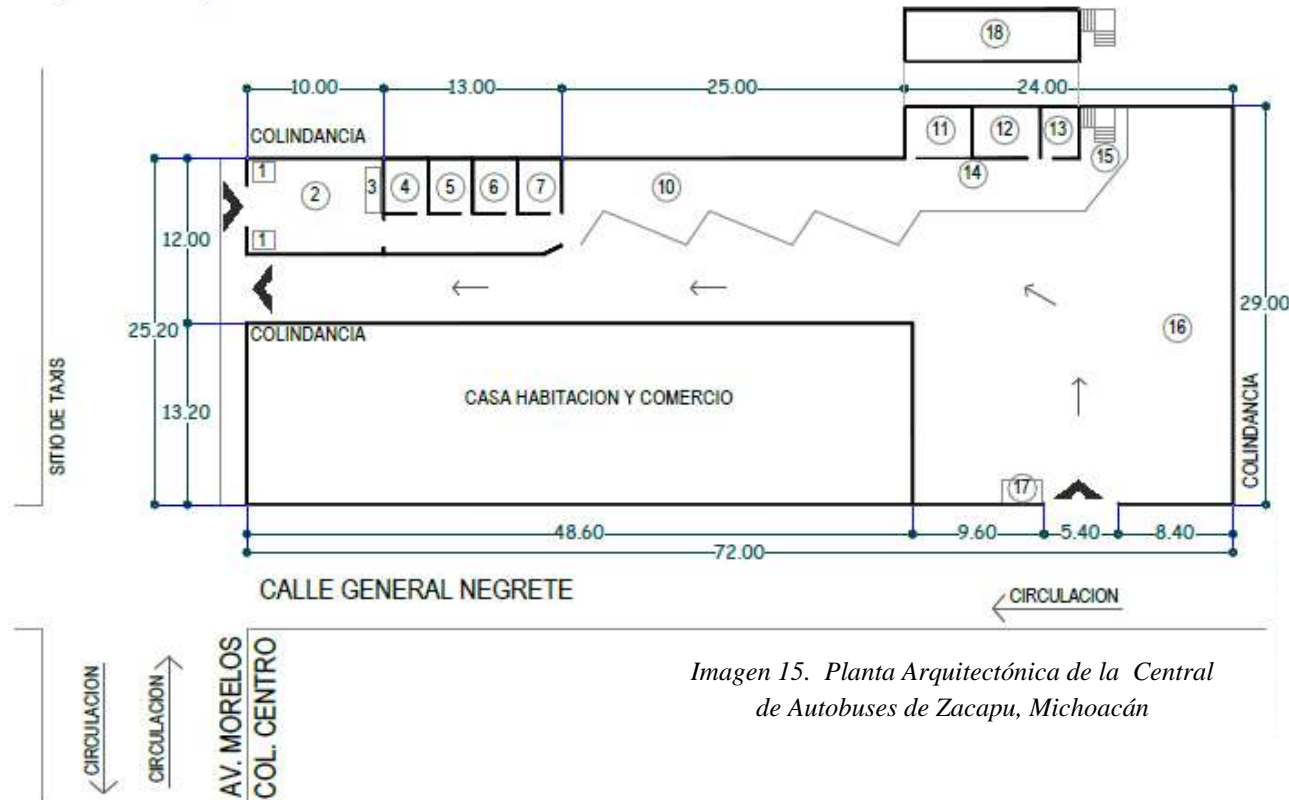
Planta Arquitectónica de la Central de Autobuses de Zacapu, Michoacán
